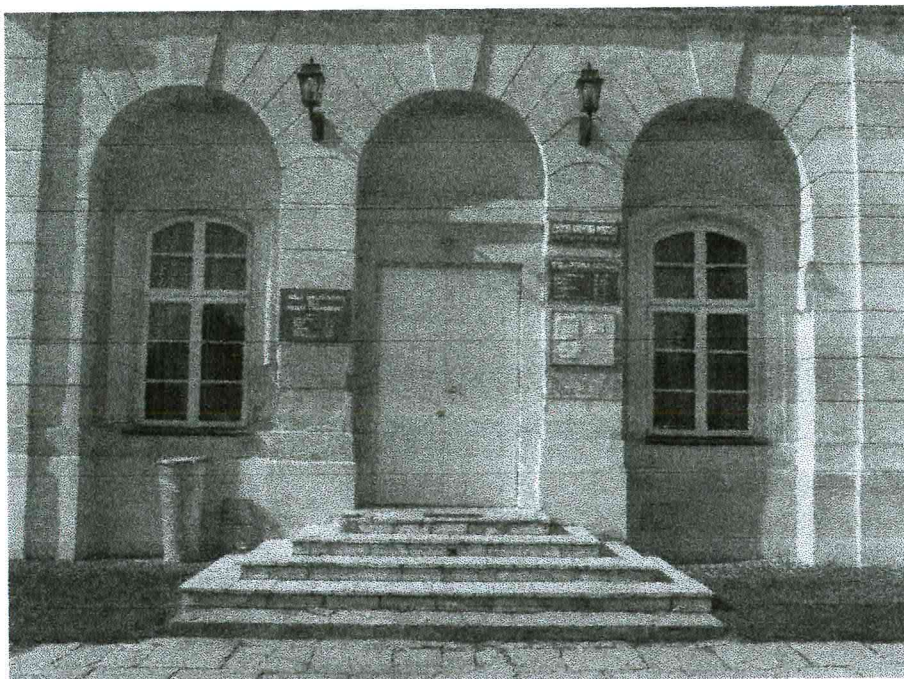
Podest żelbetowy, skrzydło zachodnie, elewacja wschodnia – S 1
